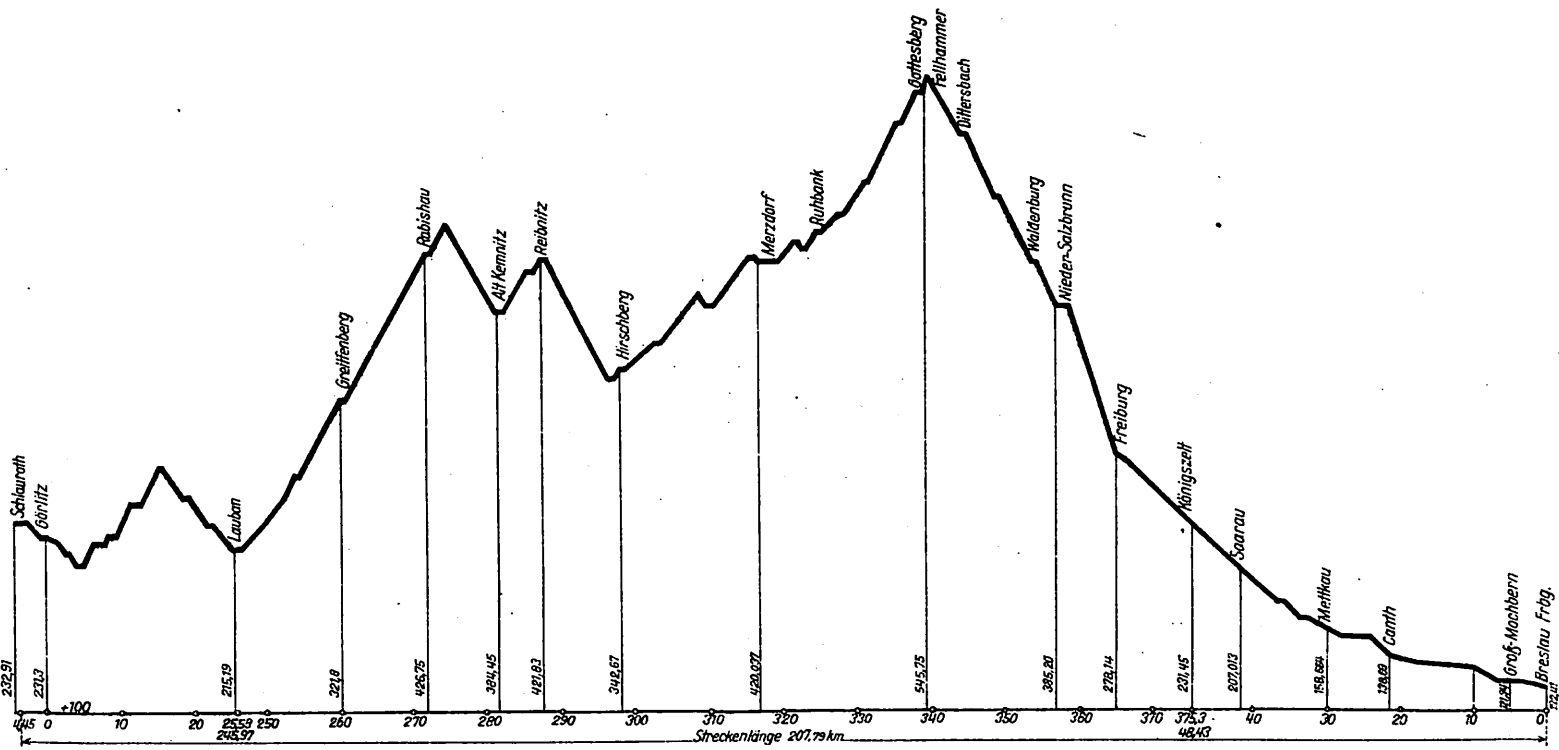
Höhenplan der Strecke Breslau- Görlitz (Schlauroth).
